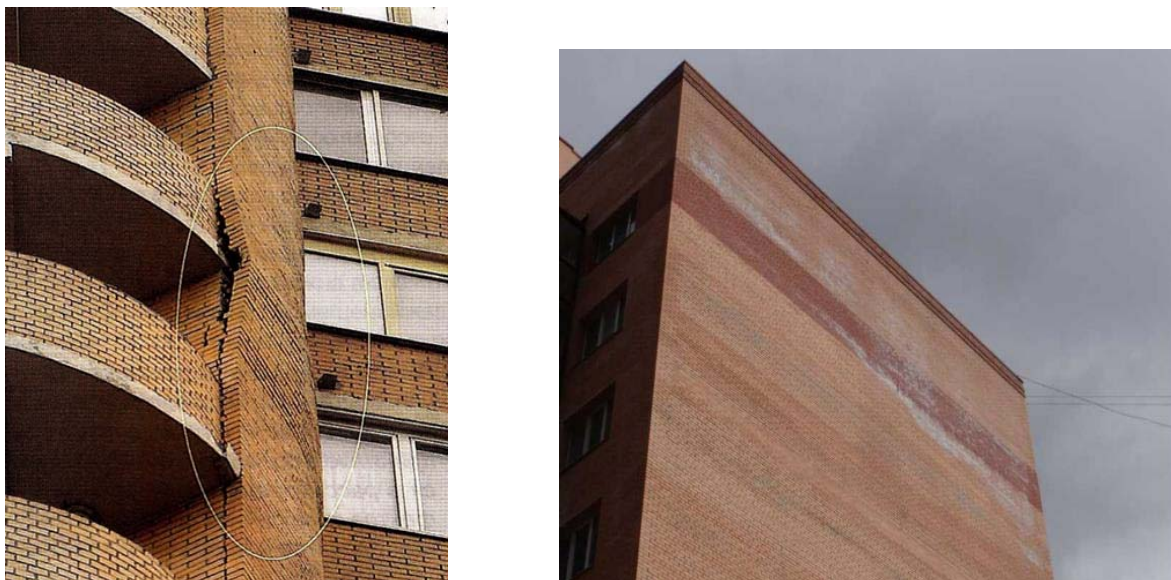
Выпучивание, потемнение кирпичной облицовки в стенах здания
